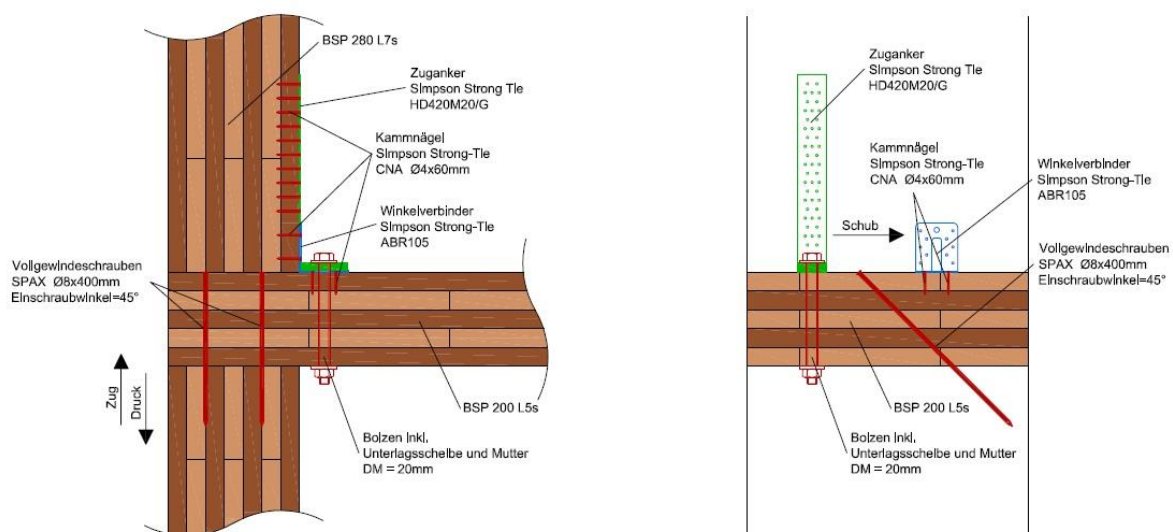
Anschlussfuge Wand-Decke-Wand
